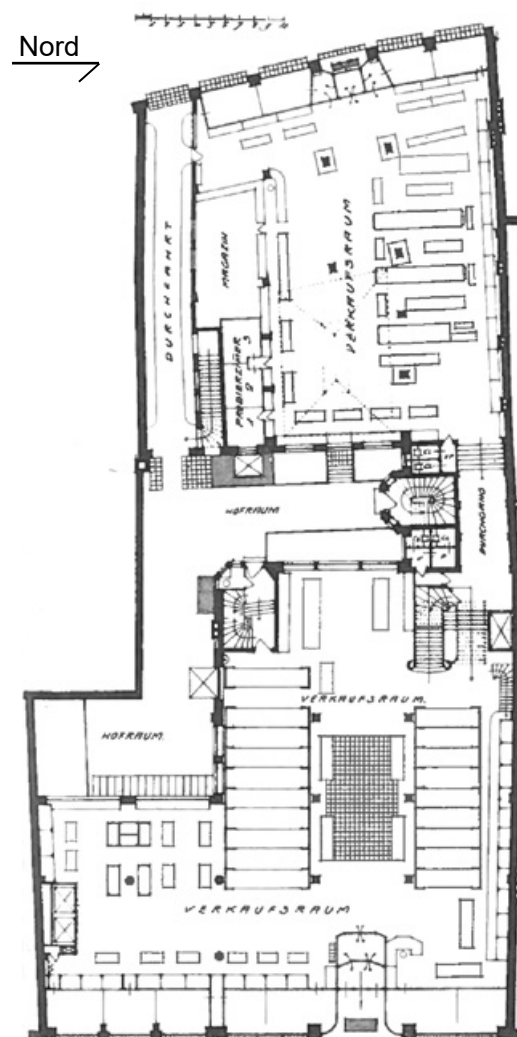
Grundriss EG (SBZ 1911, S. 378).
